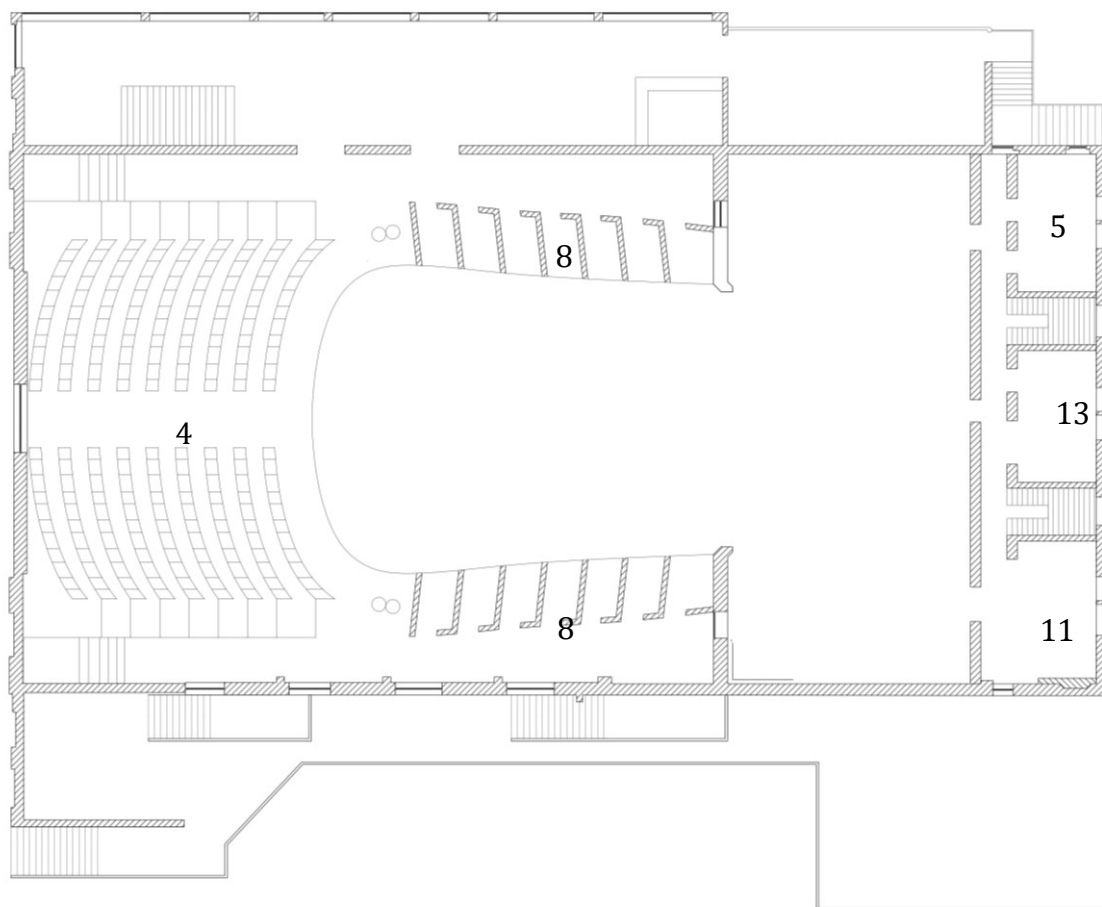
Planta original, Piso 1, Fonte: Autor
